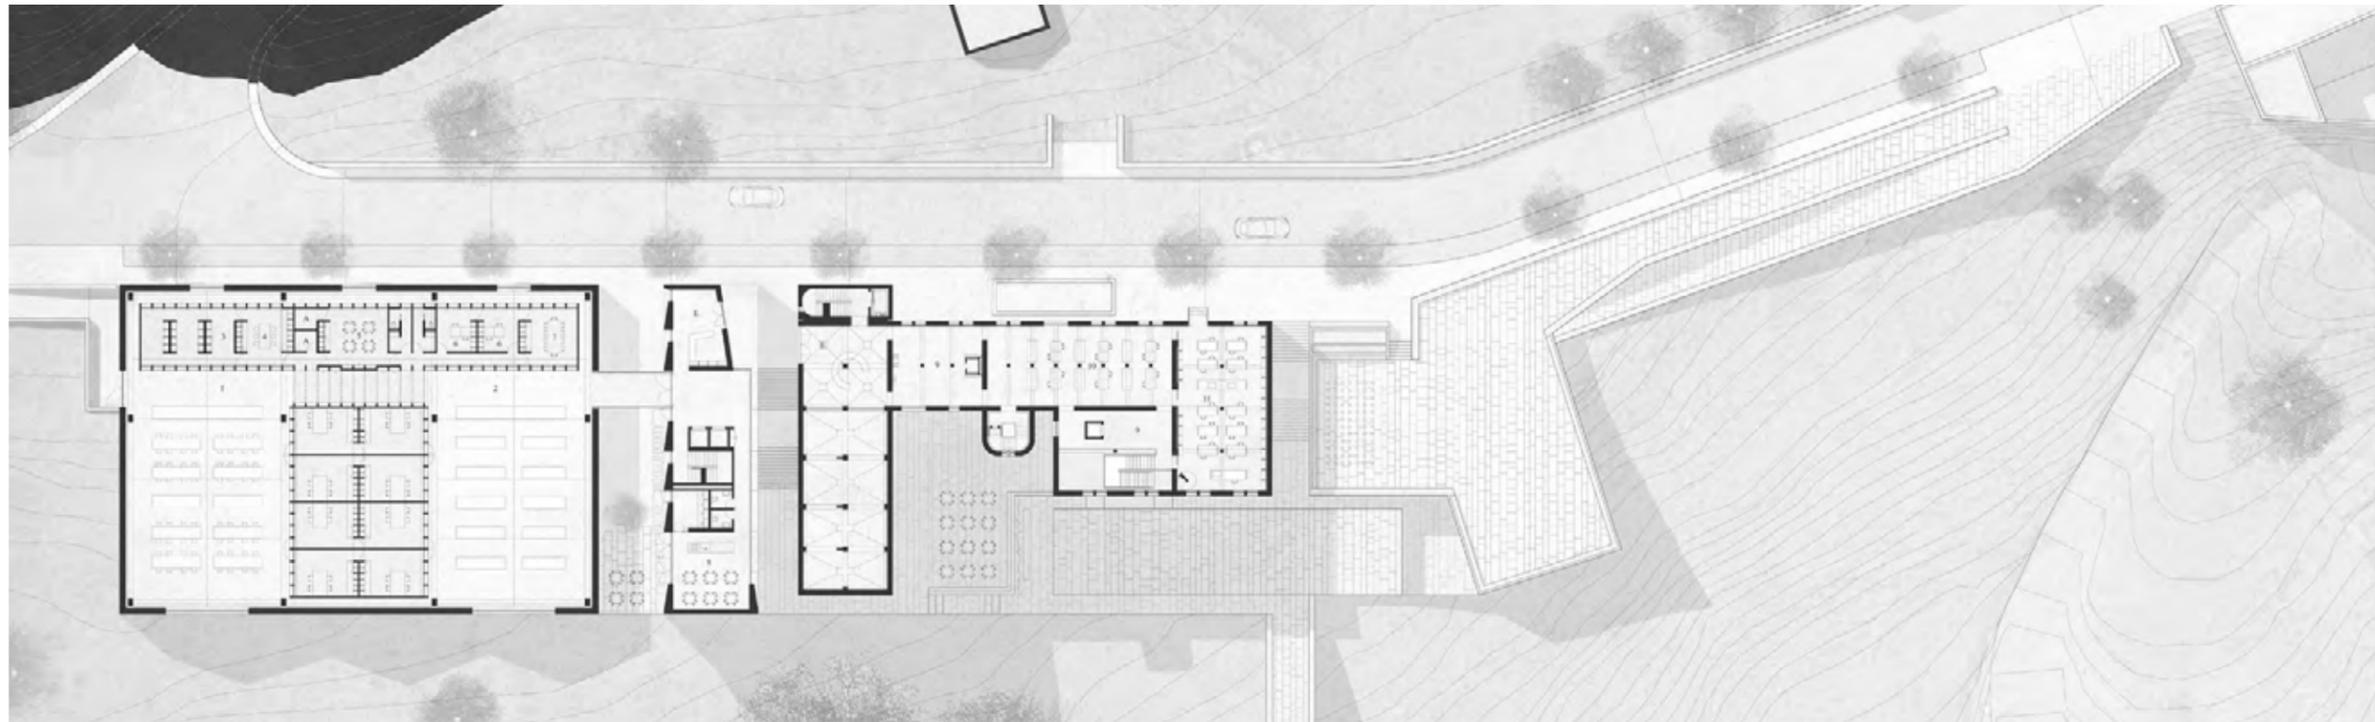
Planta do piso térreo (legenda no desenho em anexo)
